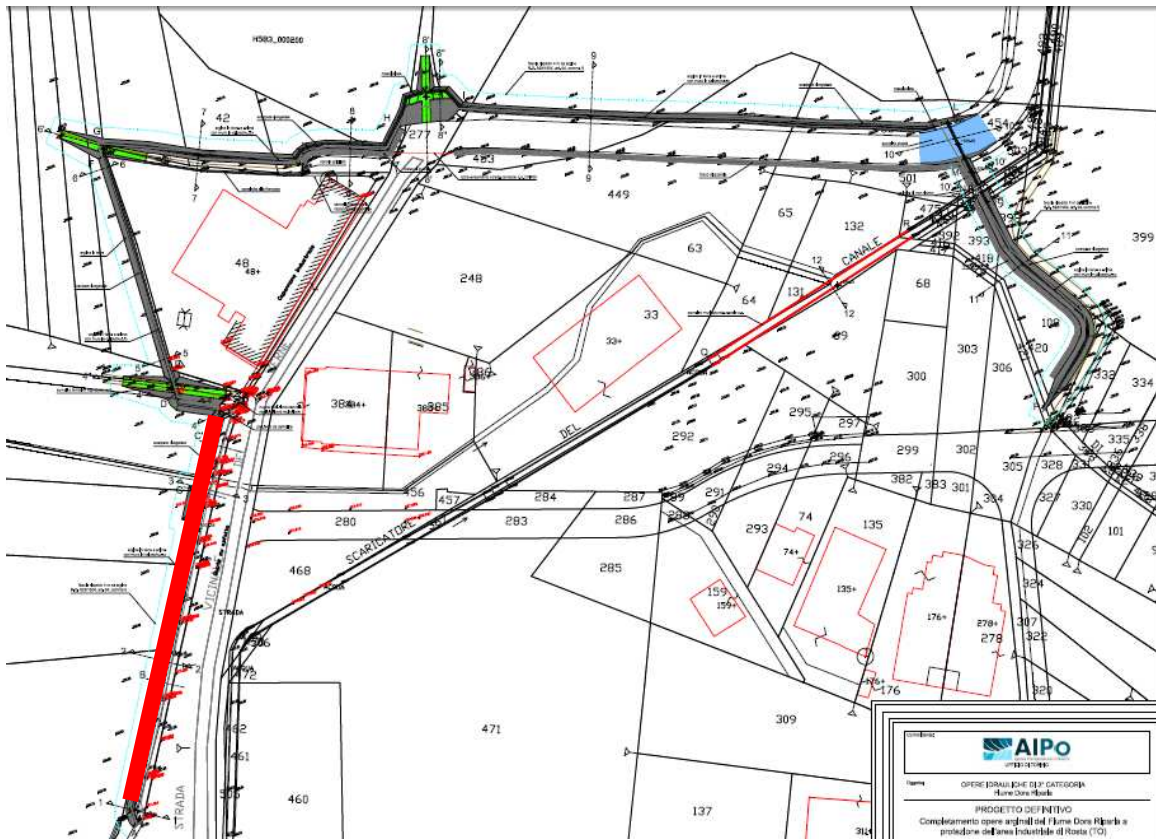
Planimetria del progetto; in rosso il tratto A – D
